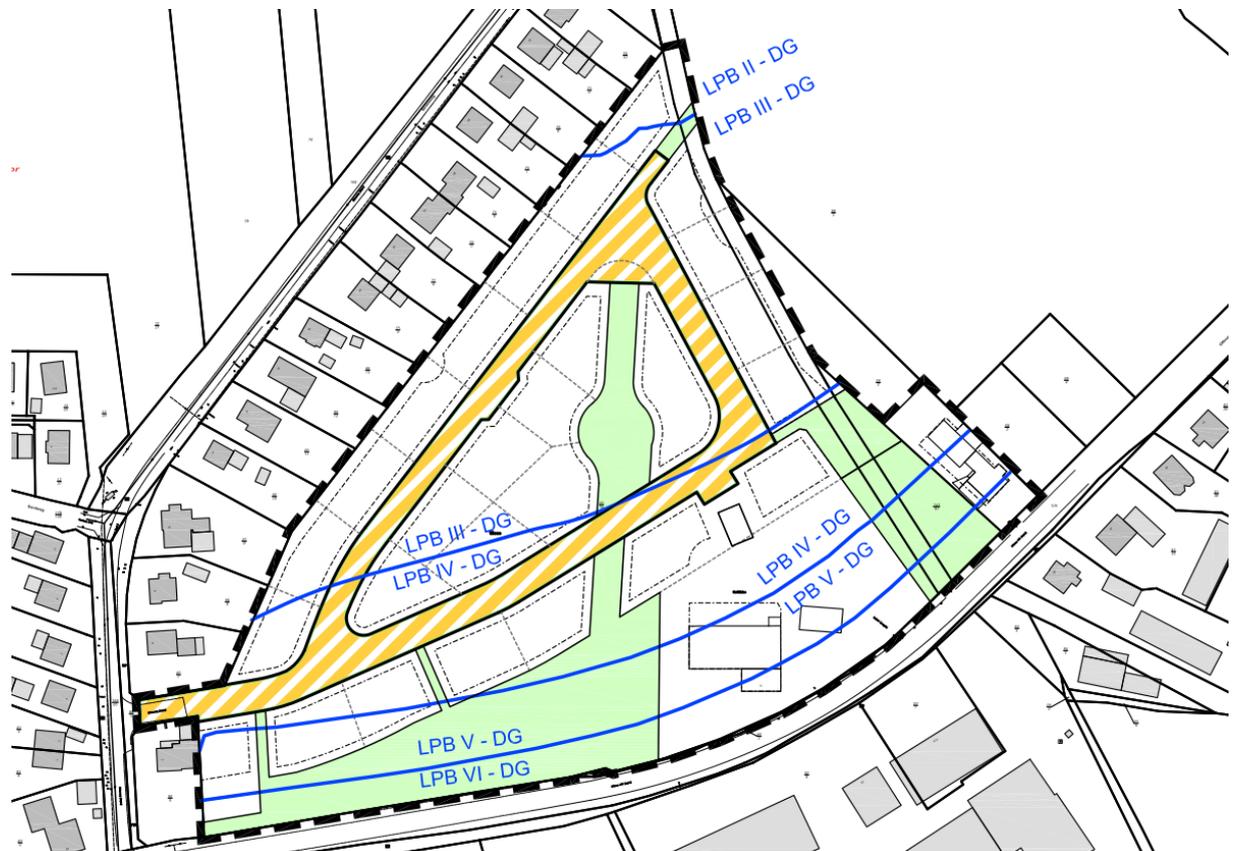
Lageplan der Lärmpegelbereiche (LPB mit römischen Ziffern z.B. IV) im Dachgeschoss (DG)
